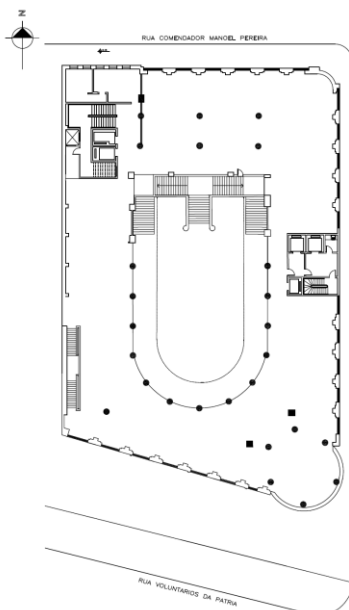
Magazine Mesbla, Porto Alegre(1944). Planta baixa sobreloja
